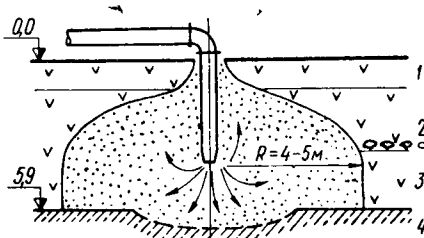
Поперечный разрез конуса размыва: 1 — неразложившийся торф; 2 — переходной слой с пнями; 3 — разложившийся торф; 4 — глина
